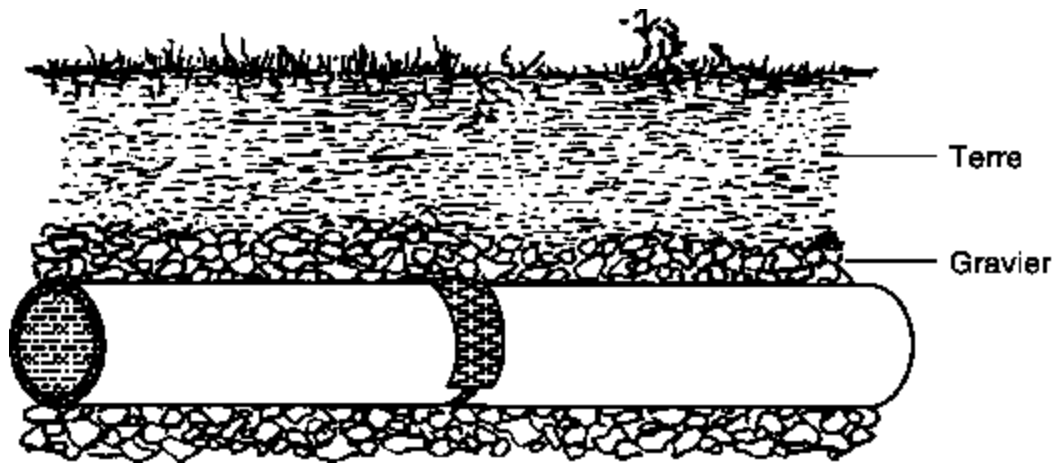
Drain enterré constitué de tuyaux en grès dont les joints ne sont pas étanchéifiés. Les joints sont recouverts d'un collier d'argile, de papier kraft ou de tout autre matériau résistant (133).
